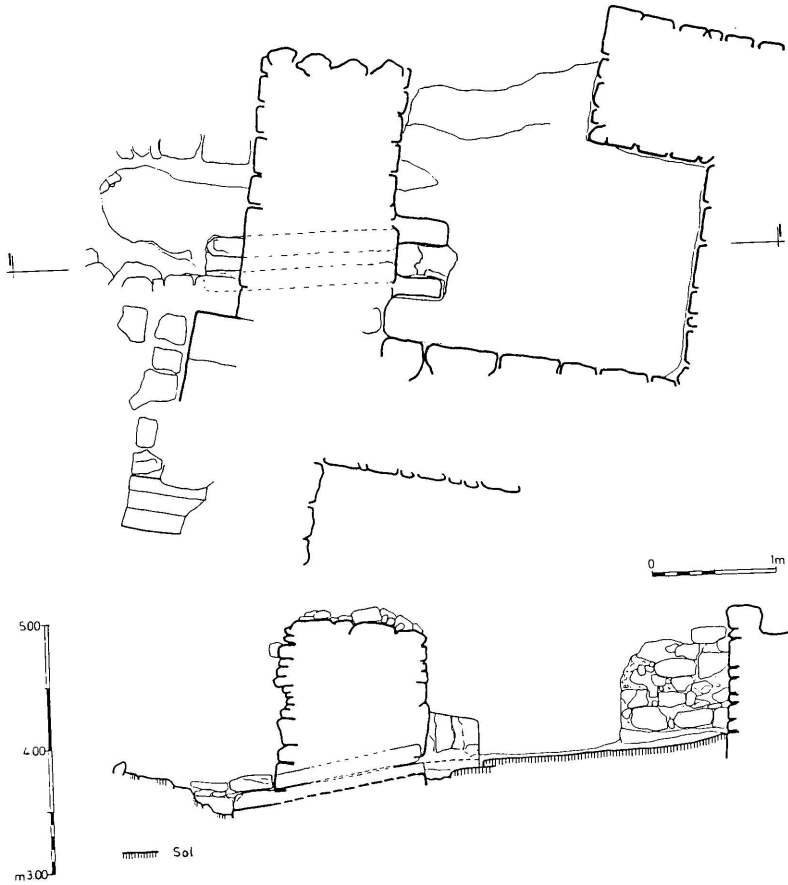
Palais Nord. L'installation hydraulique de la pièce XXIV. Plan et coupe (relevé S. Macharqa, 1991).
